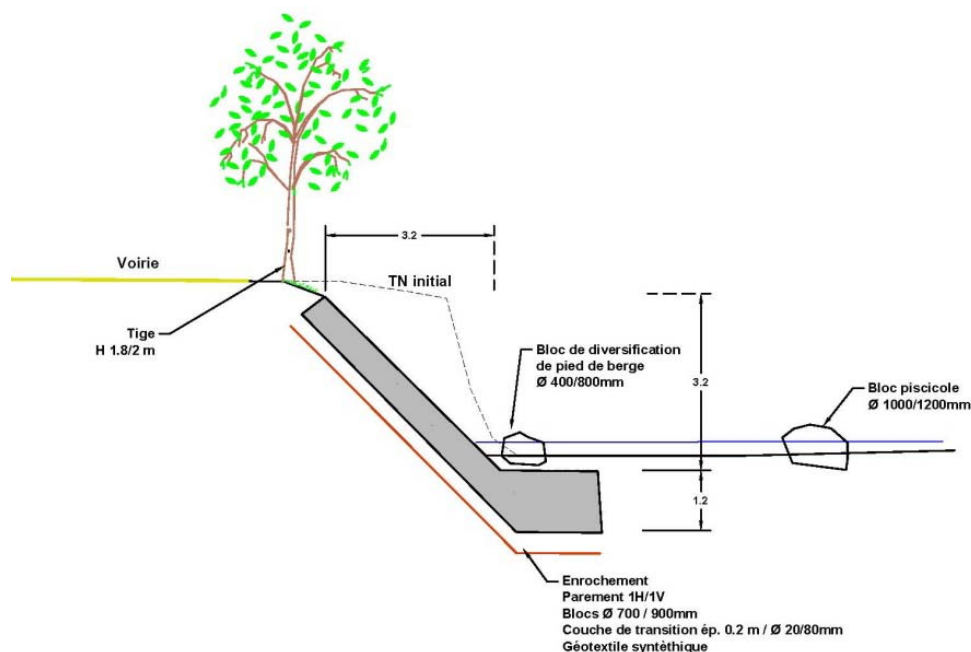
Aménagement de la Bienne au niveau de la rue Pierre Morel – Coupe 4
